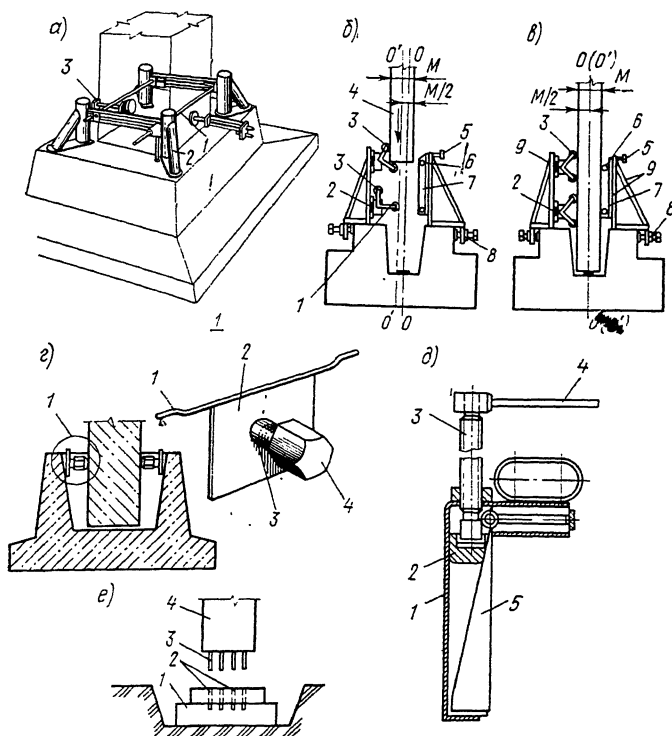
Кондукторы и приспособления для временного крепления и выверки колонн
